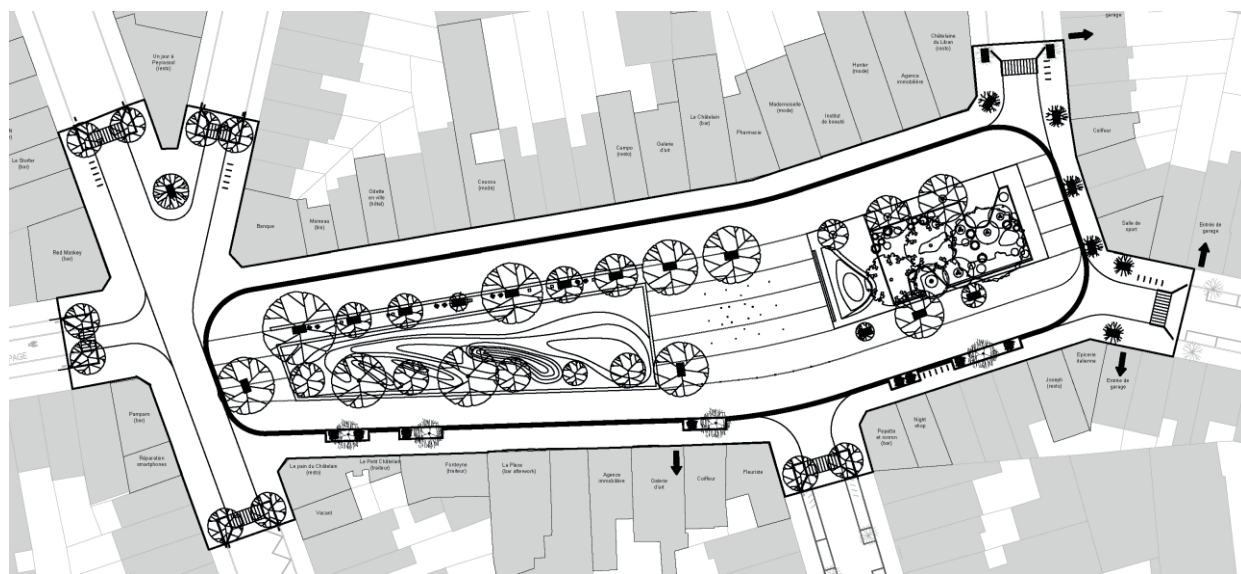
Plan d'aménagement de la Place du Châtelain -© TAKTYK
